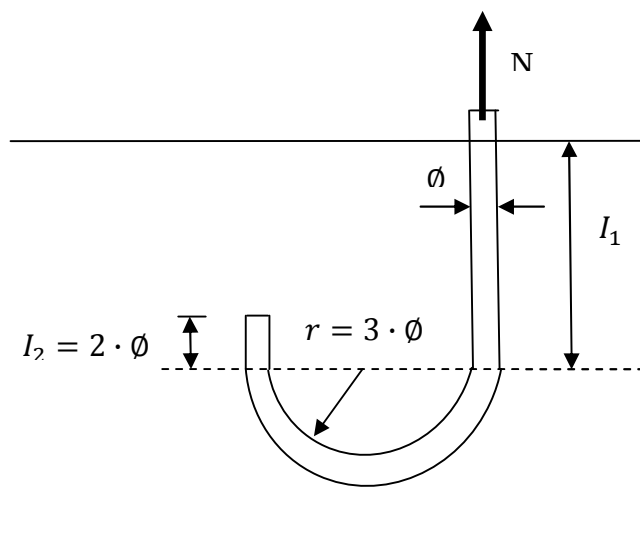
Tige d'ancrage du pied de poteaux.
